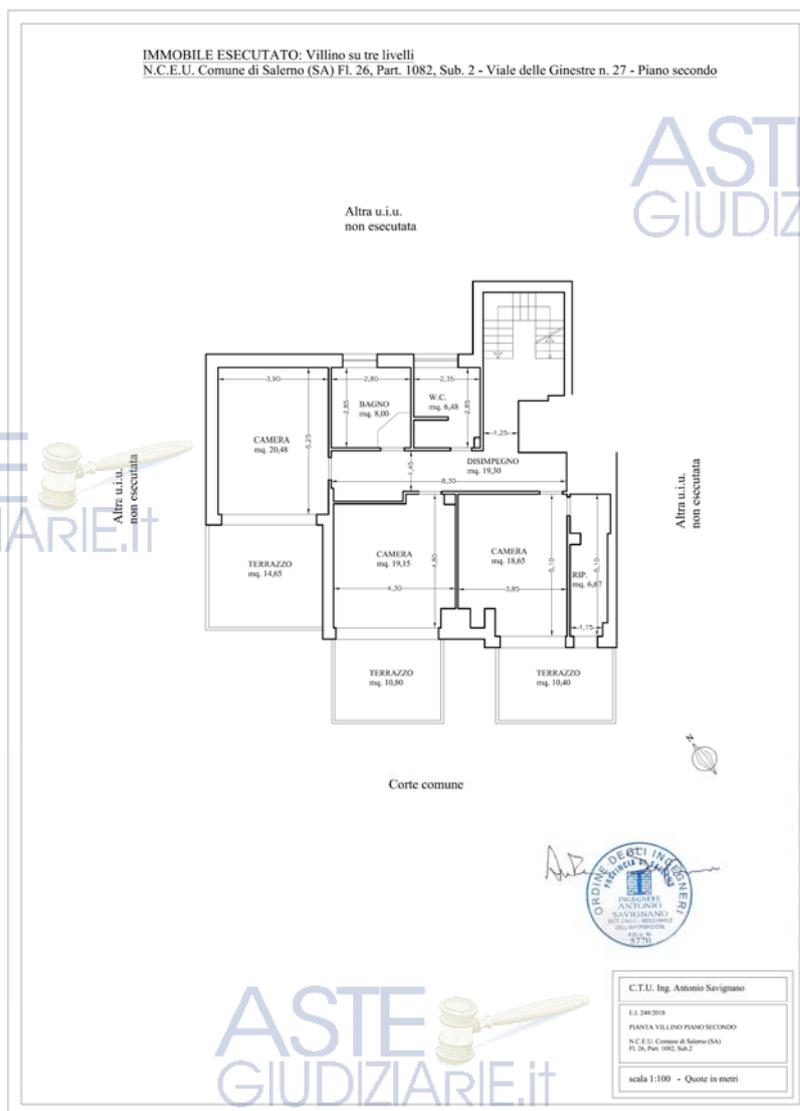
Planimetria digitalizzata dello stato di fatto relativamente al piano secondo del Lotto n. 7.
